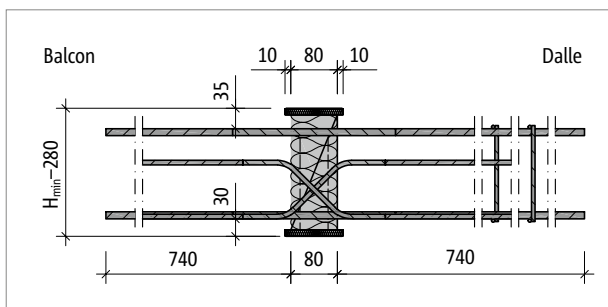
Schöck Isokorb® T types D-MM1-VV1 à MM5-VV1 à CV35 : coupe du produit
